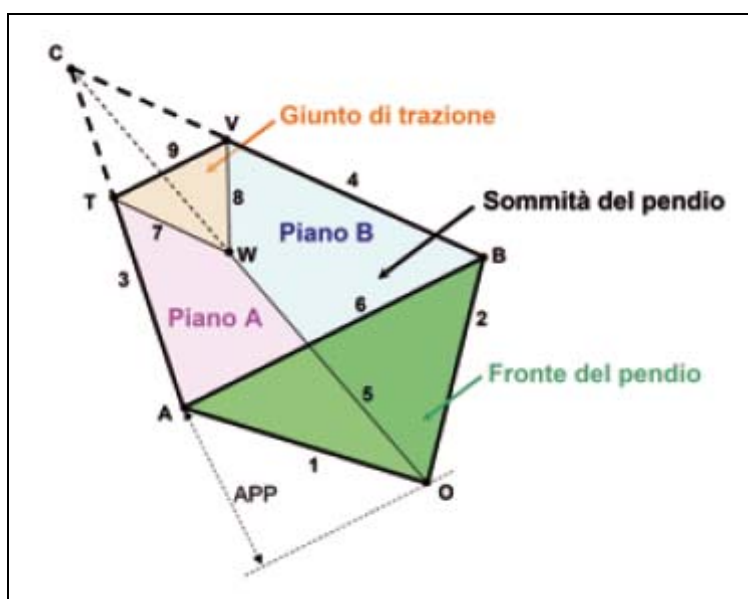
schema per la definizione dei piani nel caso di instabilità di cunei di roccia.
